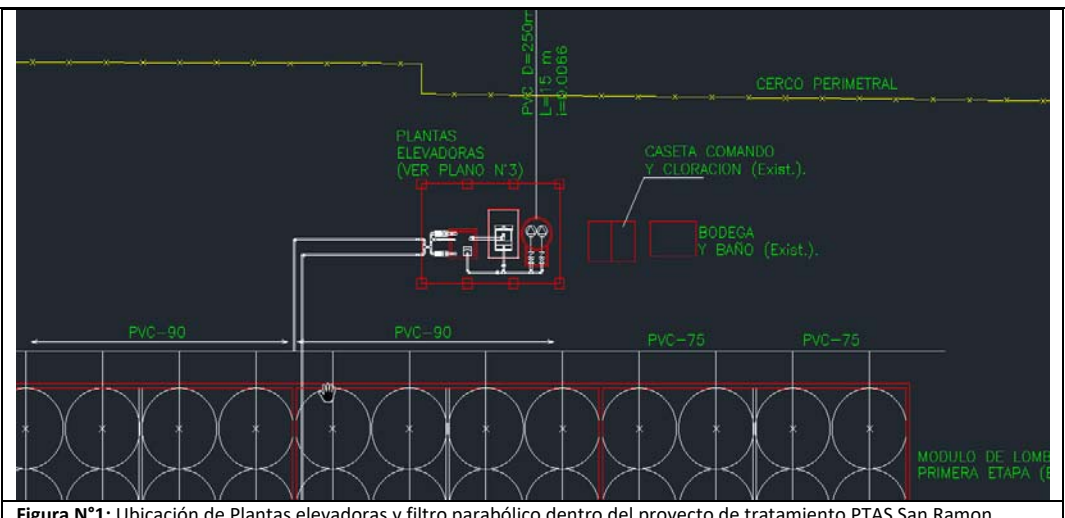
Ubicación de Plantas elevadoras y filtro parabólico dentro del proyecto de tratamiento PTAS San Ramon
